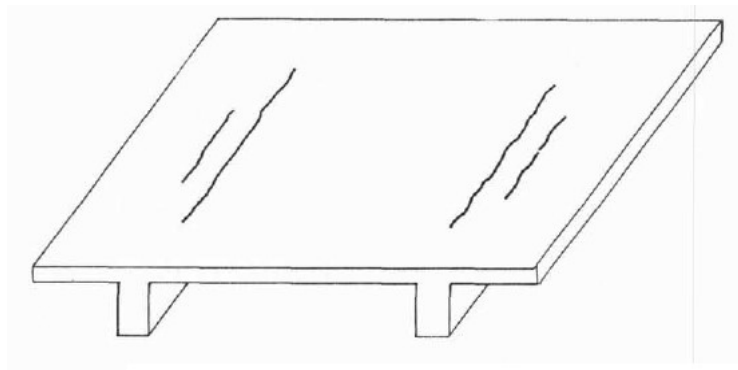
Fissuras na face superior de lajes, não contendo armadura negativa entre os painéis.
